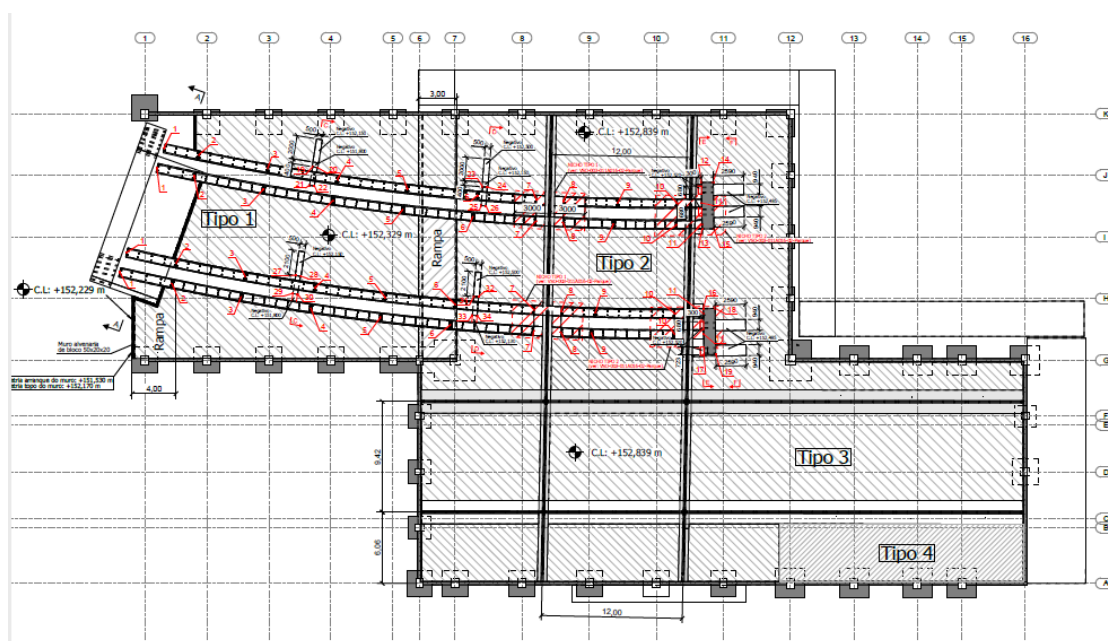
Planta de Implantação do Parque de Deslize
